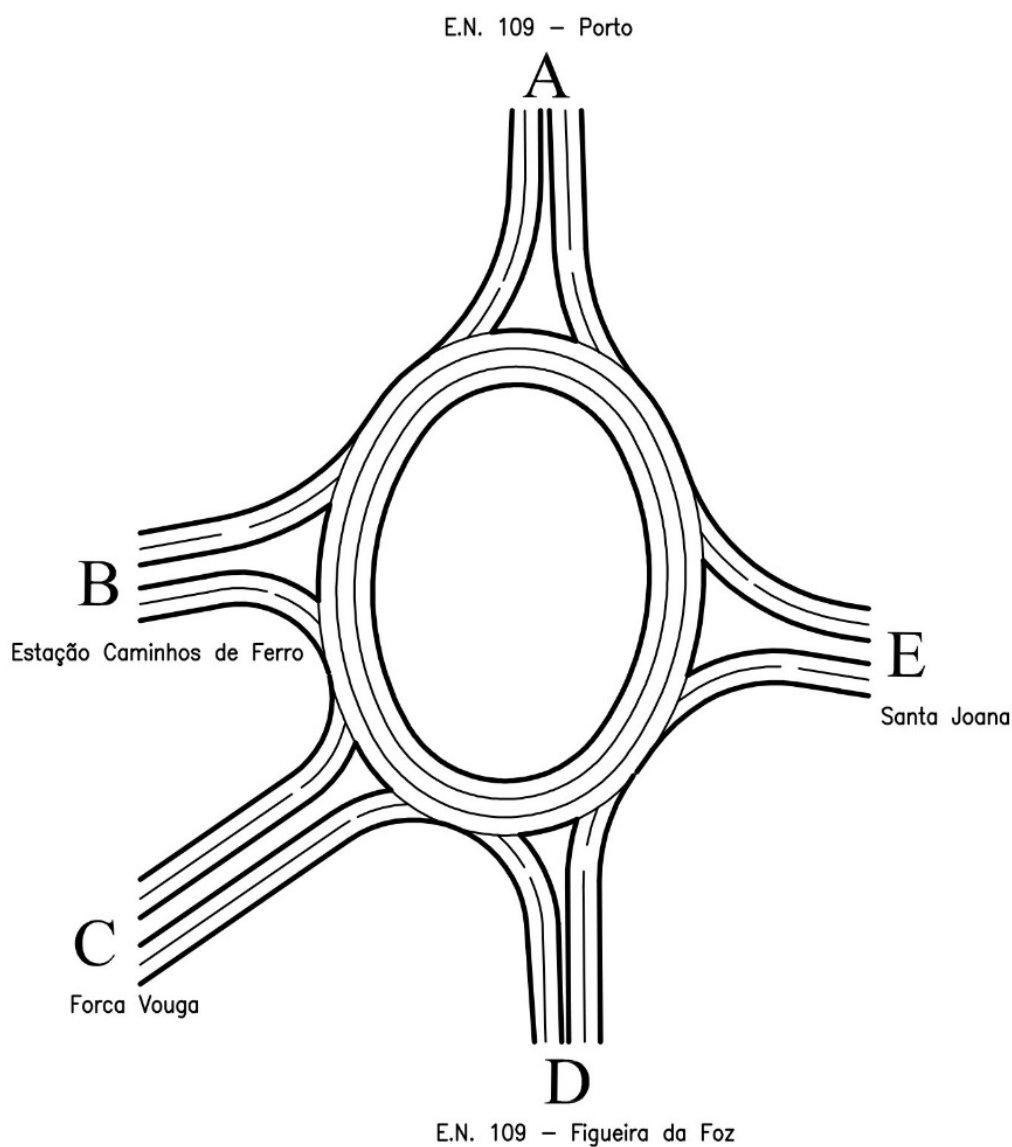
Planta Referenciada da Rotunda da Policlínica
